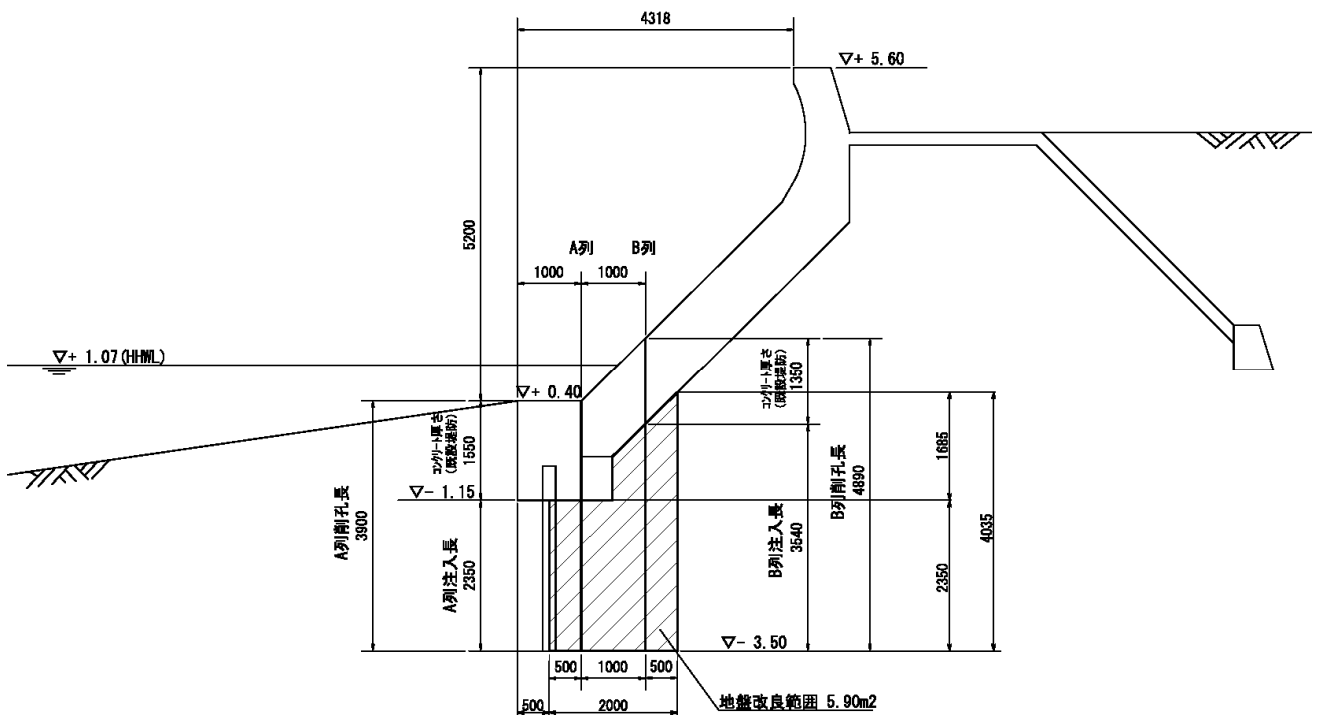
施工事例 地盤改良工標準断面図（下新川海岸・目川）
